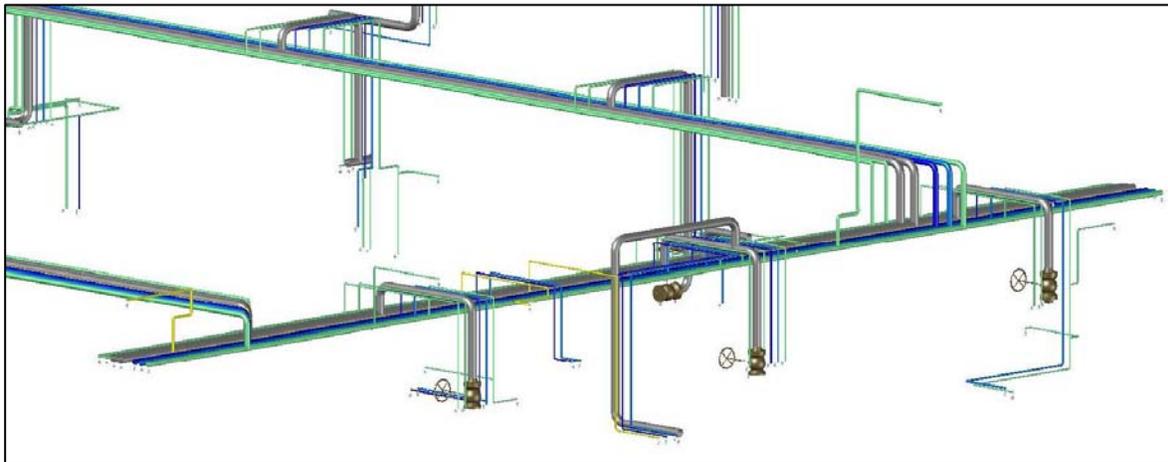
Modelo 3D de Tuberías en Planta Piloto FES Zaragoza (Vista 2).
